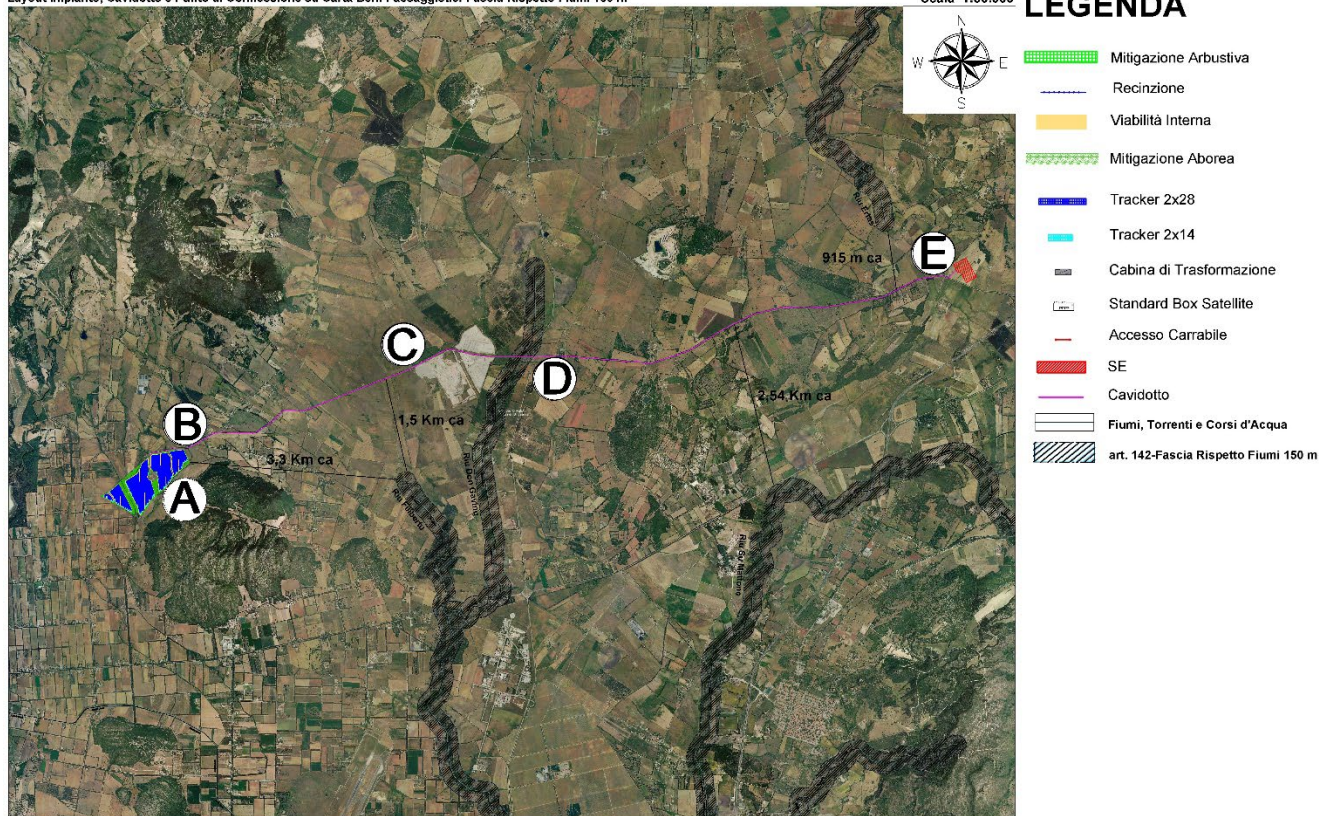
Layout Impianto e Cavidotto su Fascia Rispetto Fiumi 150 m
